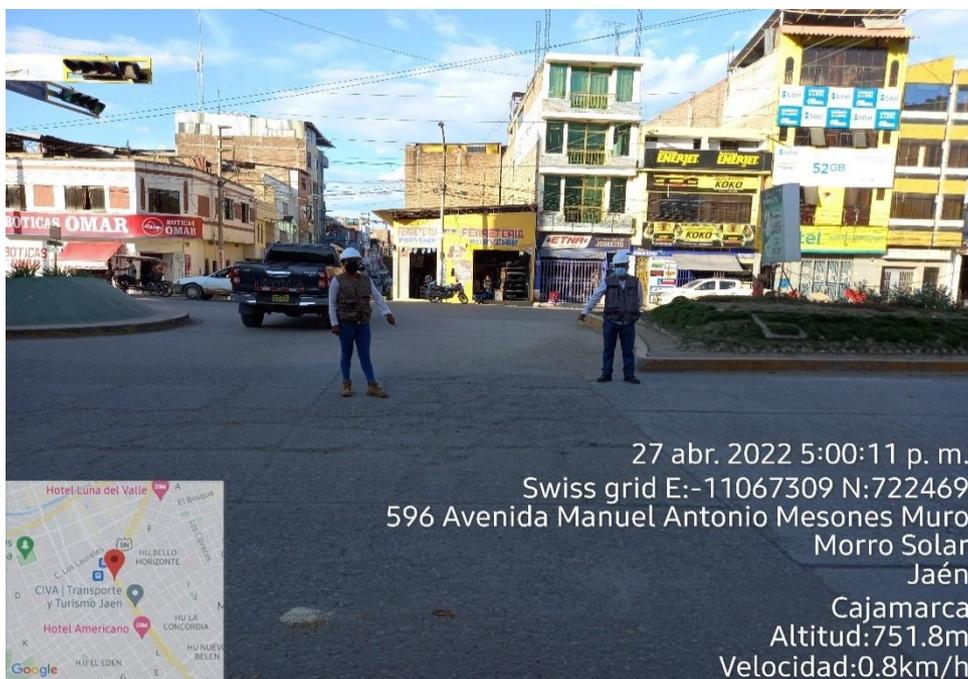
Identificando el deterioro del Pavimento de la Av. Mesones Muro de la ciudad de Jaén
